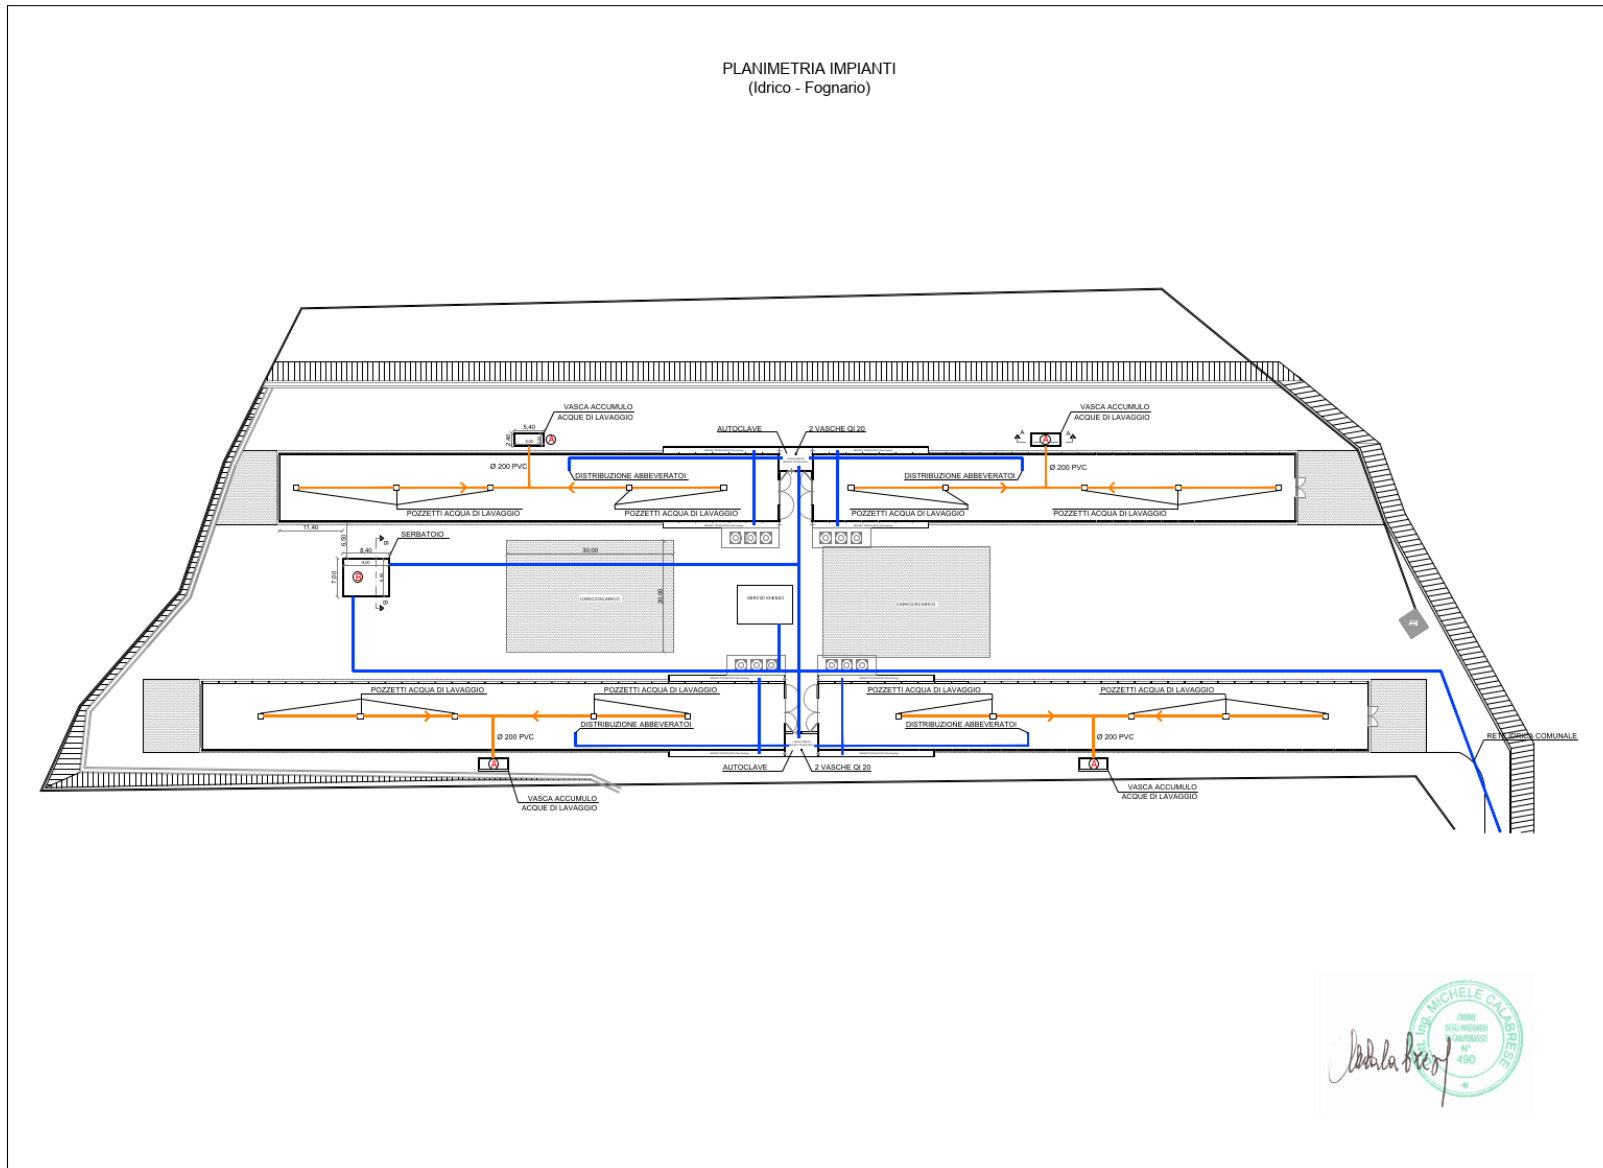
planimetria generale di stabilimento con indicazione degli impianti idrici e fognari
